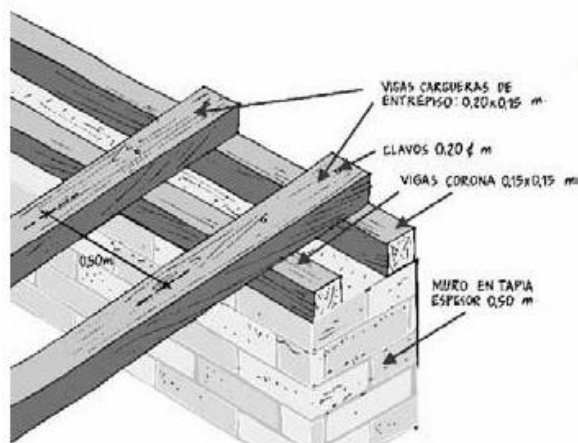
Vigas en madera para sistema de entepiso aligerado
